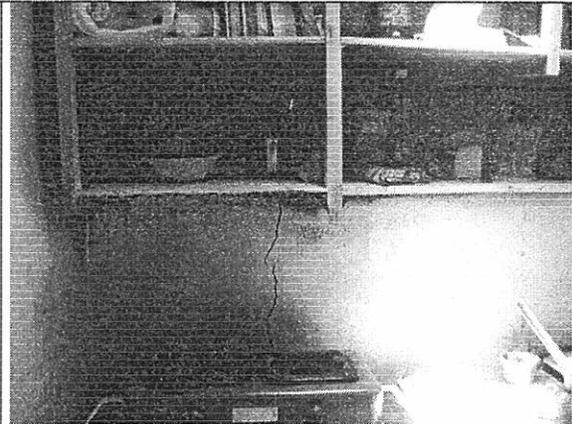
Agrietamiento en muro del tercer piso.
